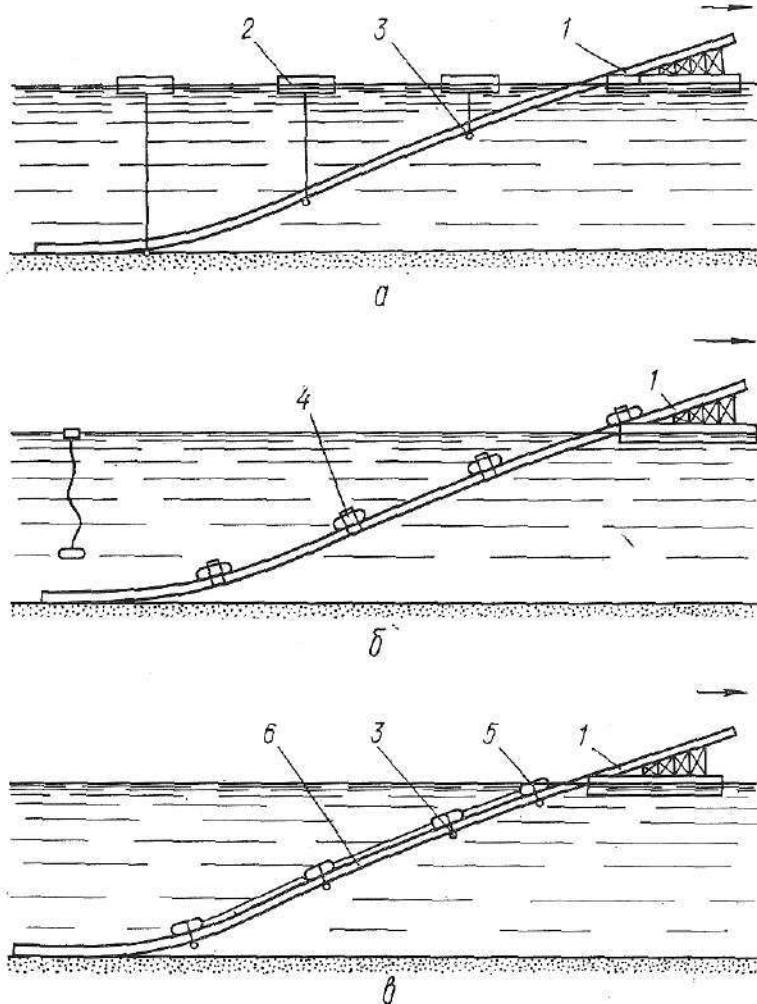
Схема укладки трубопроводов с плавучих средств способом нарашивания:
